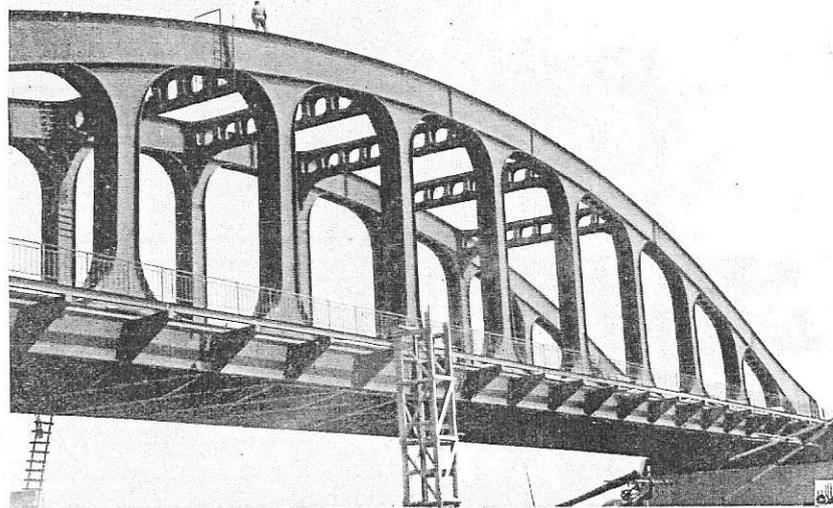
Le contreventement supérieur est assuré par des poutres du type Vierendeel en caisson. L'ouvrier debout sur la membrure supérieure donne une idée des importantes dimensions de cet ouvrage.
